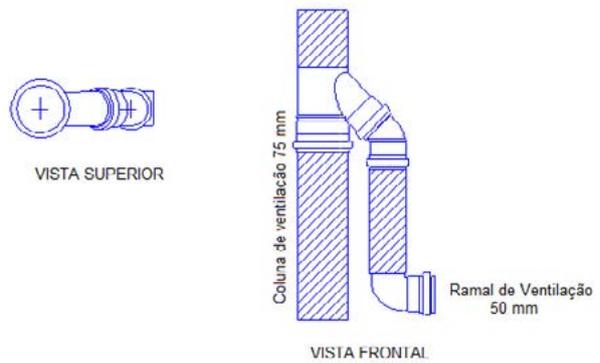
Detalhe da ligação do ramal de ventilação com a coluna de ventilação
